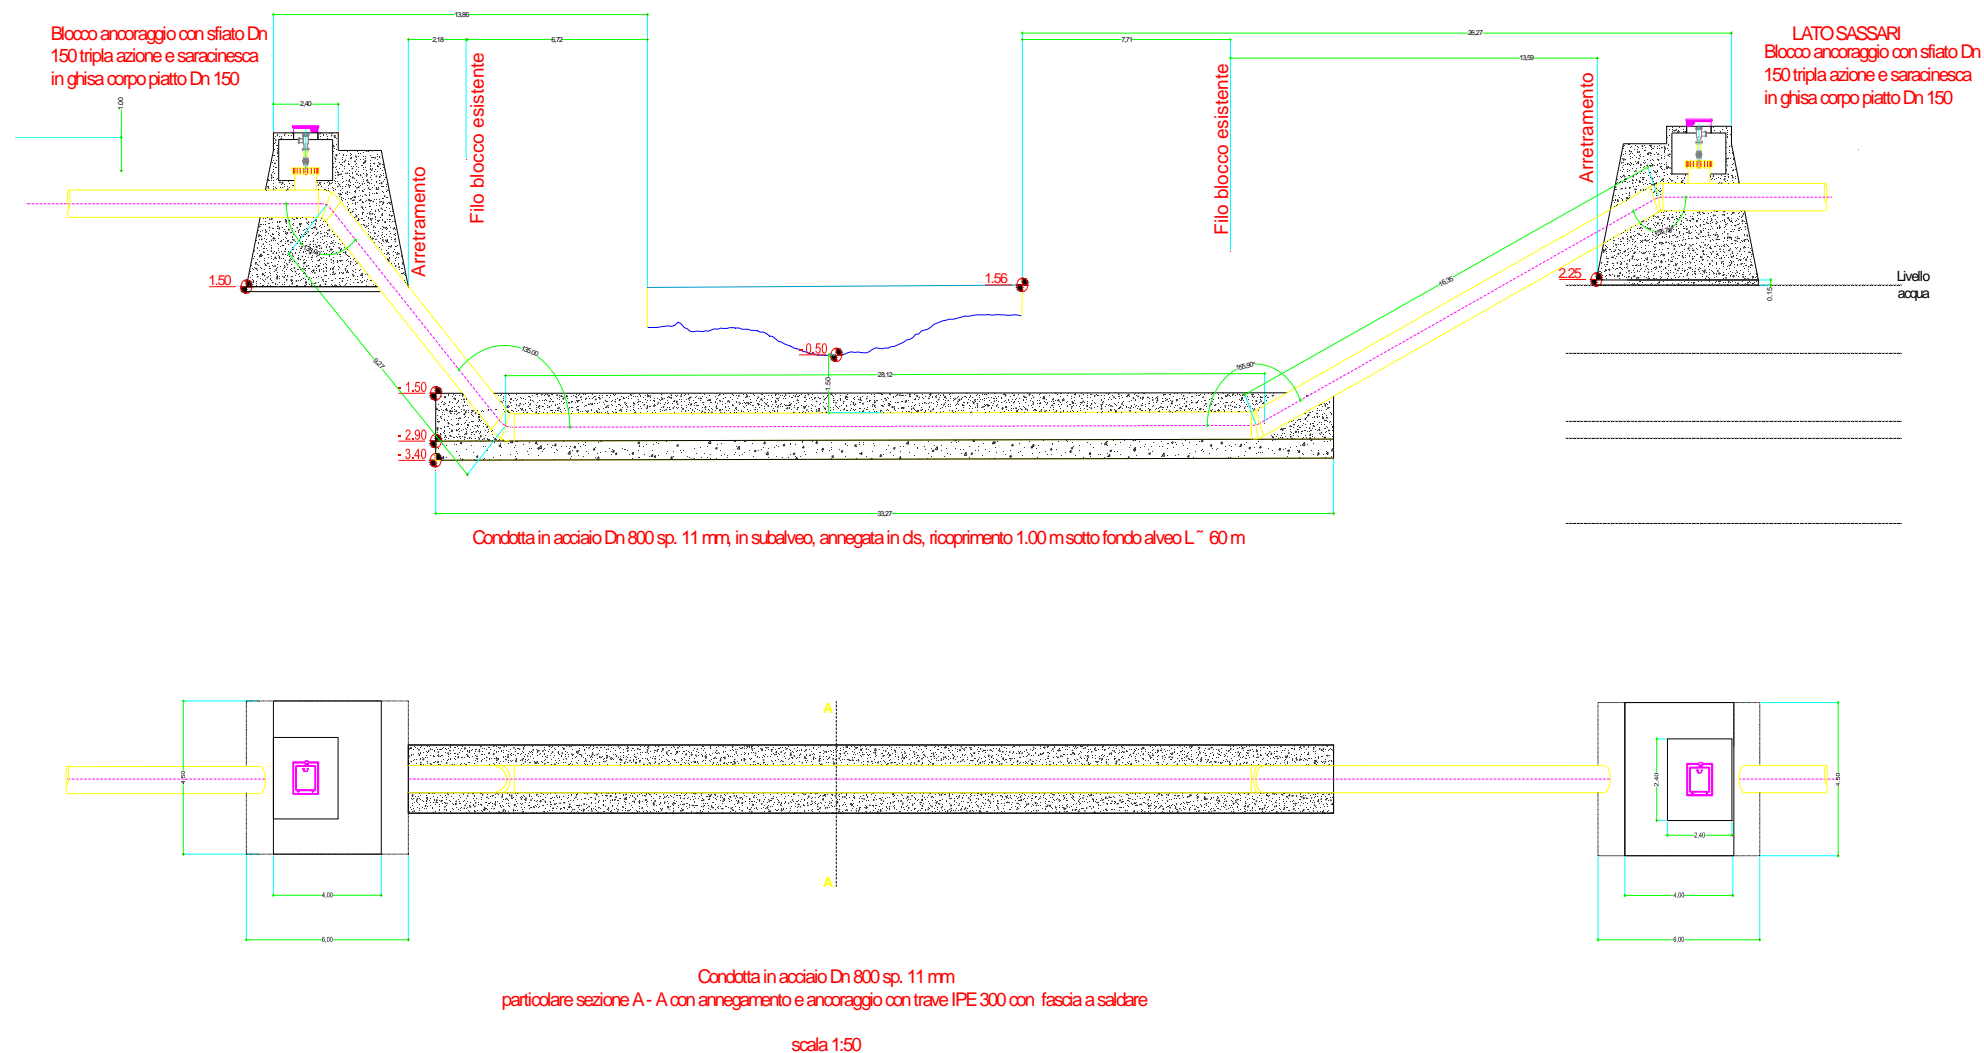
Planimetria e sezione longitudinale dell'opera esistente (in magenta) ed in progetto.
